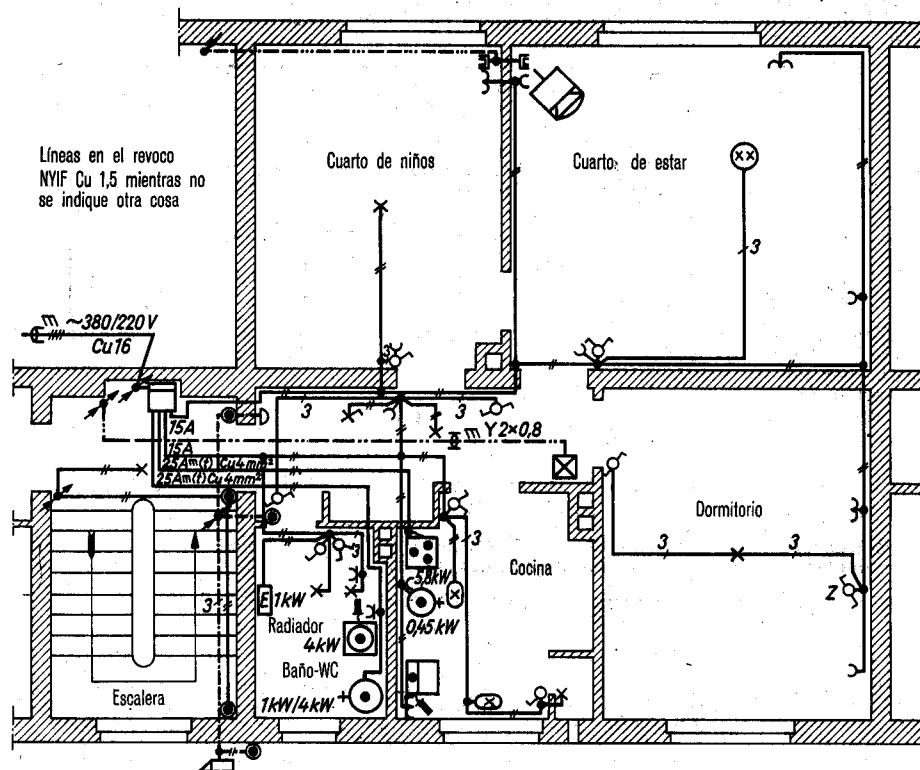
Plano de instalación eléctrica de una vivienda.
